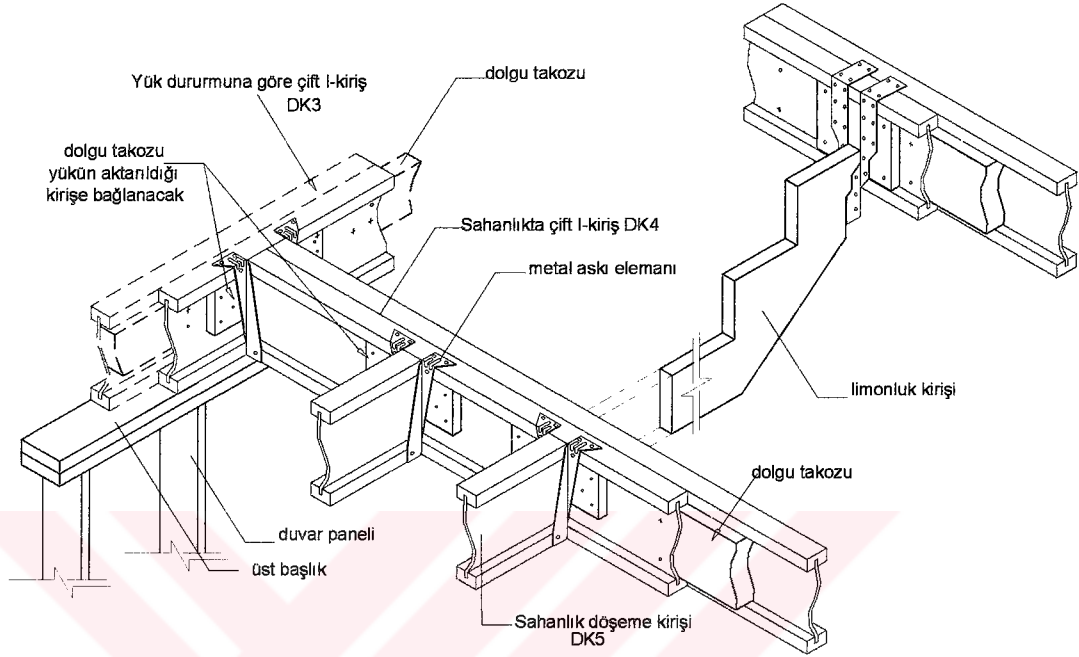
Duvar paneli–Döşeme kirişi bağlantı detayı Aksonometrik açılımı,
